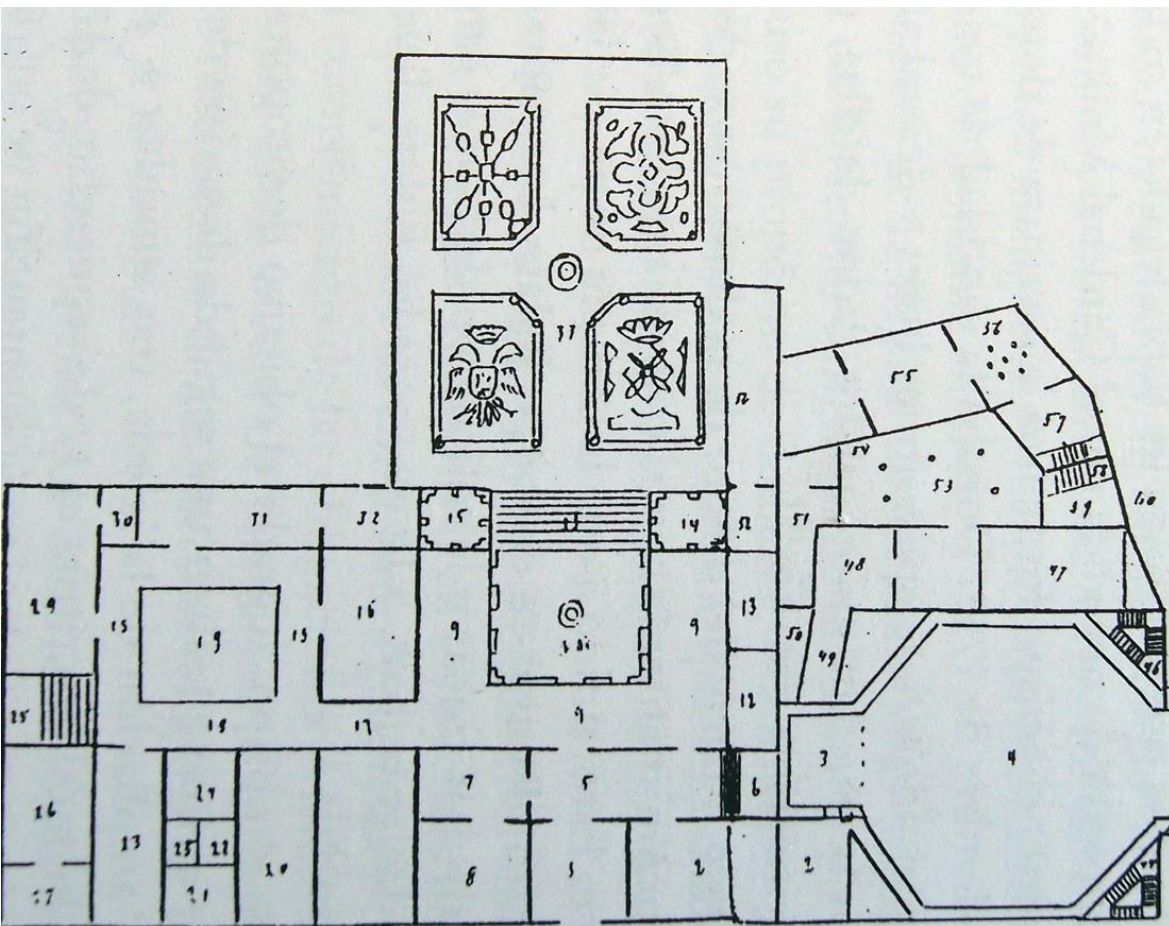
Plano general de la planta de la casa con los jardines, 1788. Padre Zamora.
